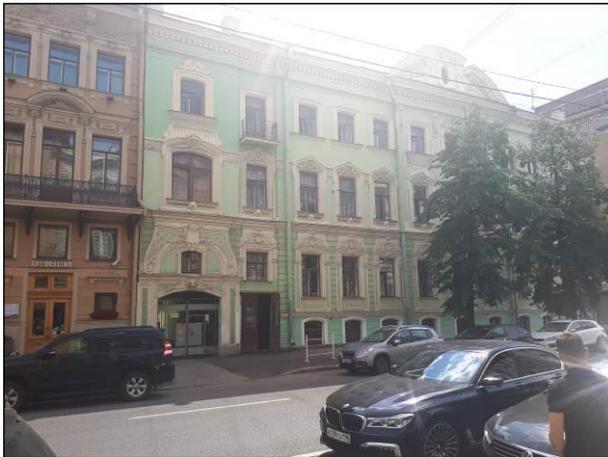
Фасад здания со стороны Большой Морской улицы (арка – вход во двор)
